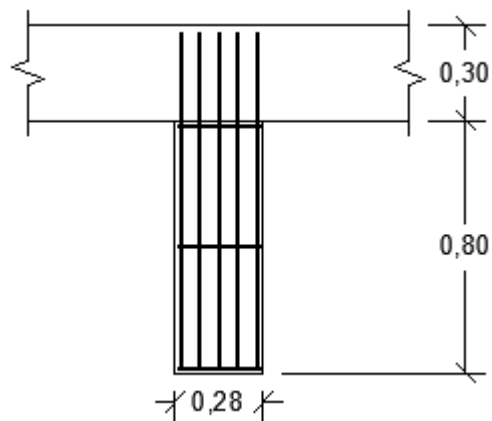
Vista superior de um degrau da escada engastada com degraus isolados. Apresenta o detalhamento das armaduras longitudinais e de distribuição. As medidas estão apresentadas em metros (Fonte: autor).
